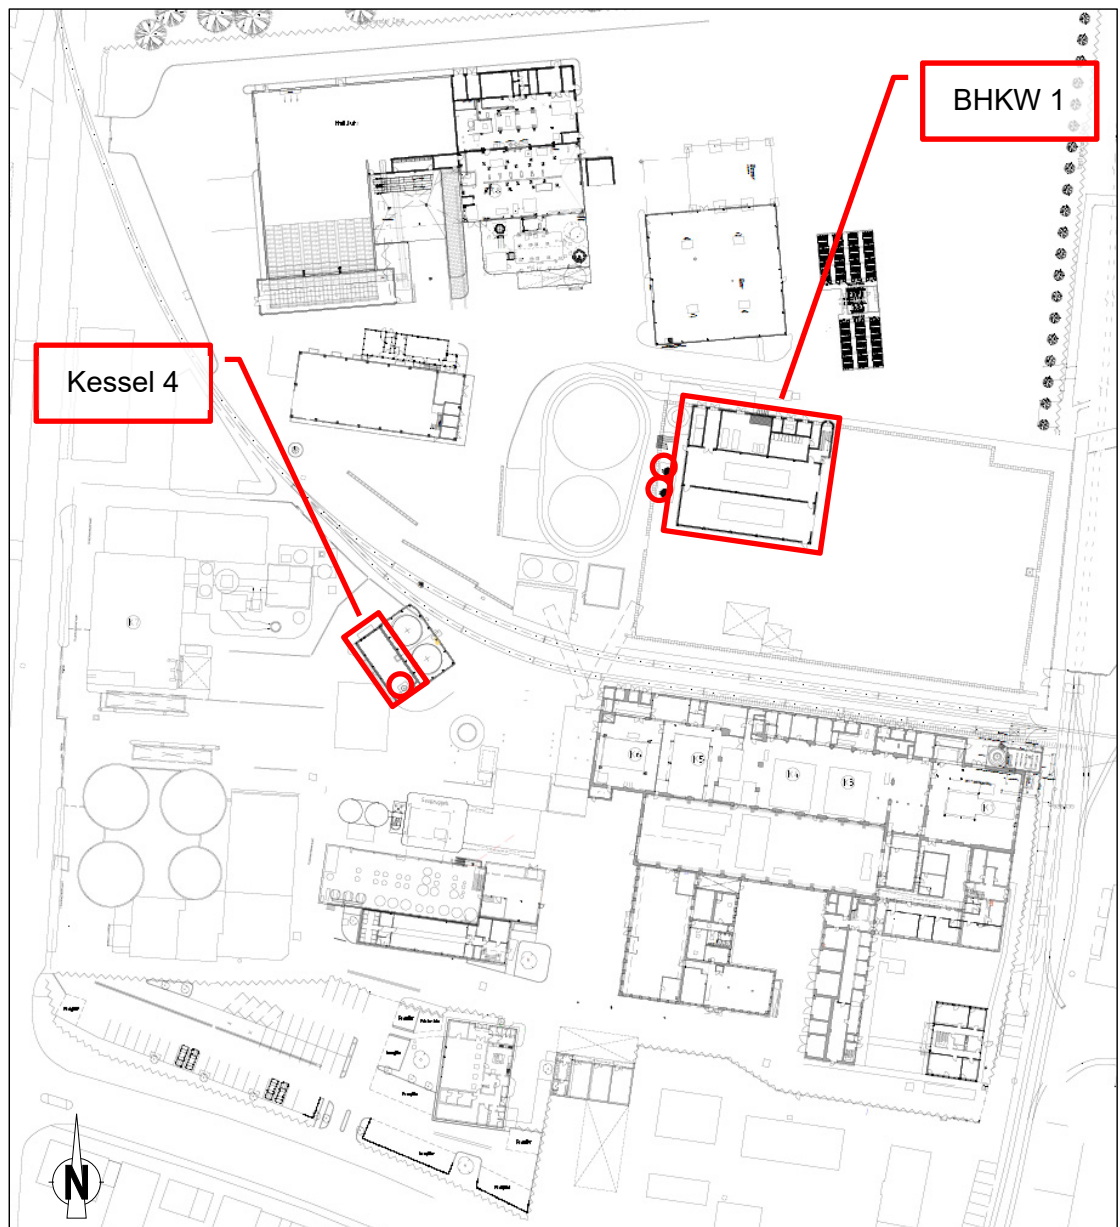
Lageplan des Standorts mit Lage des geplanten BHKW 1 und des Kessels 4 (Lage der neuen Schornsteine: rote Kreise) [75]
